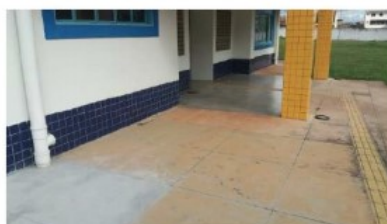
Piso de concreto do hall de entrada com acabamento ruim
